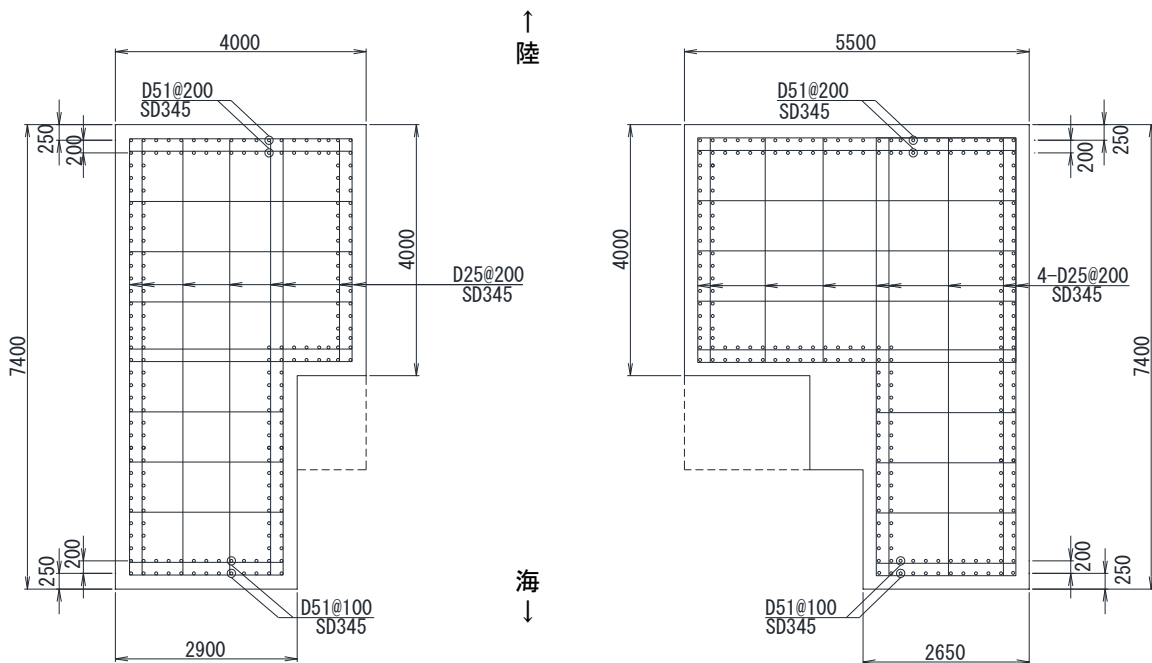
漂流物対策工戸当り (RC支柱) の概略配筋図 (A-A断面)
